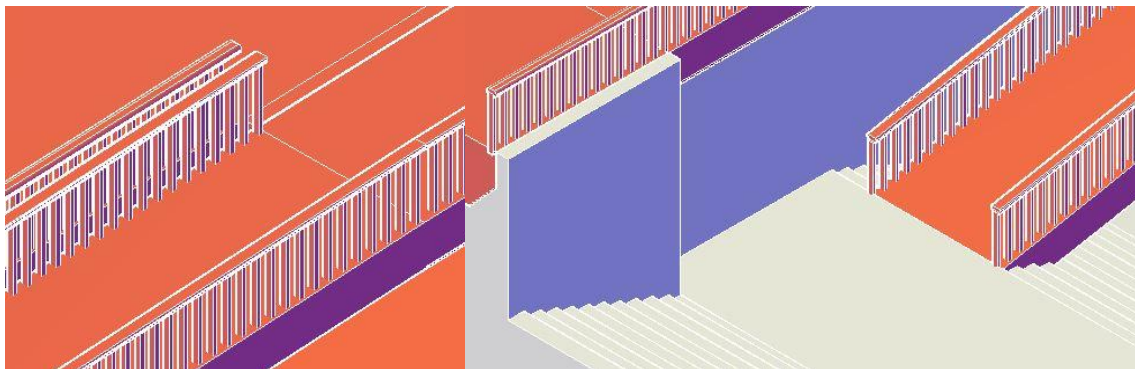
Vista isométrica del detalle de las barandillas en el punto de separación del acerado.
